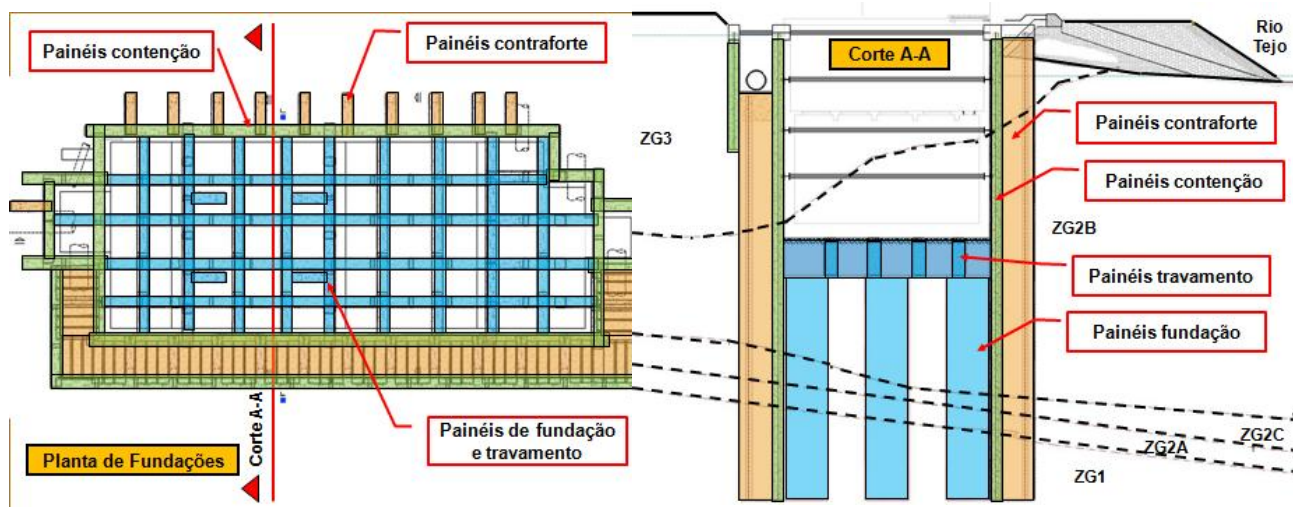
Planta e corte da estrutura de suporte da escavação da Estação Elevatória
